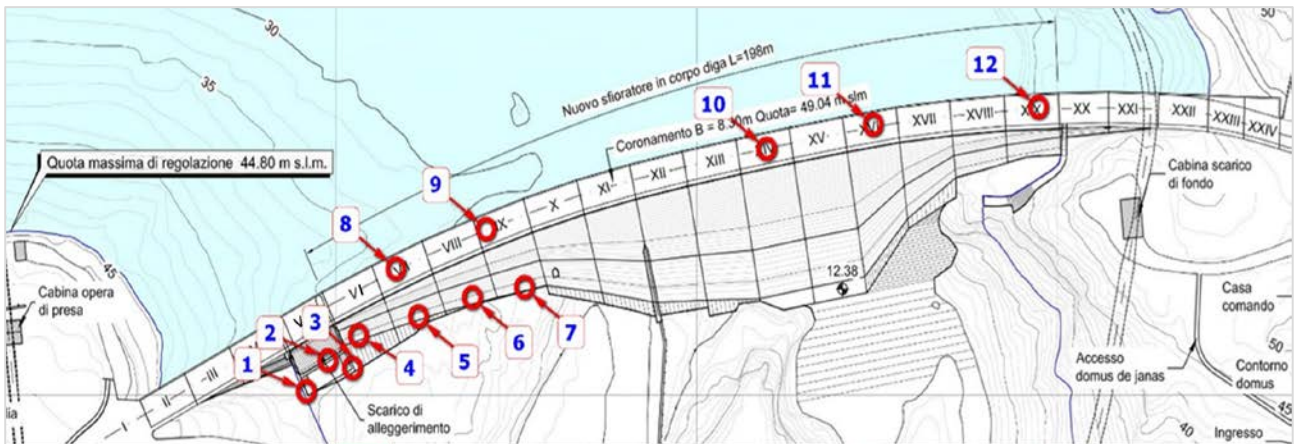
Pianta, ubicazione delle prove in situ sui calcestruzzi
